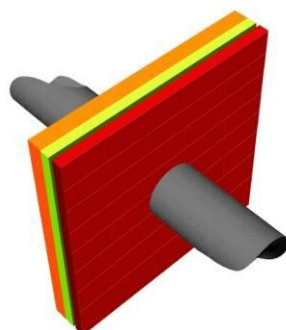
Un conduit de fumée qui traverse la couche isolante de la façade, ne doit pas être considéré comme un nœud constructif ponctuel.
